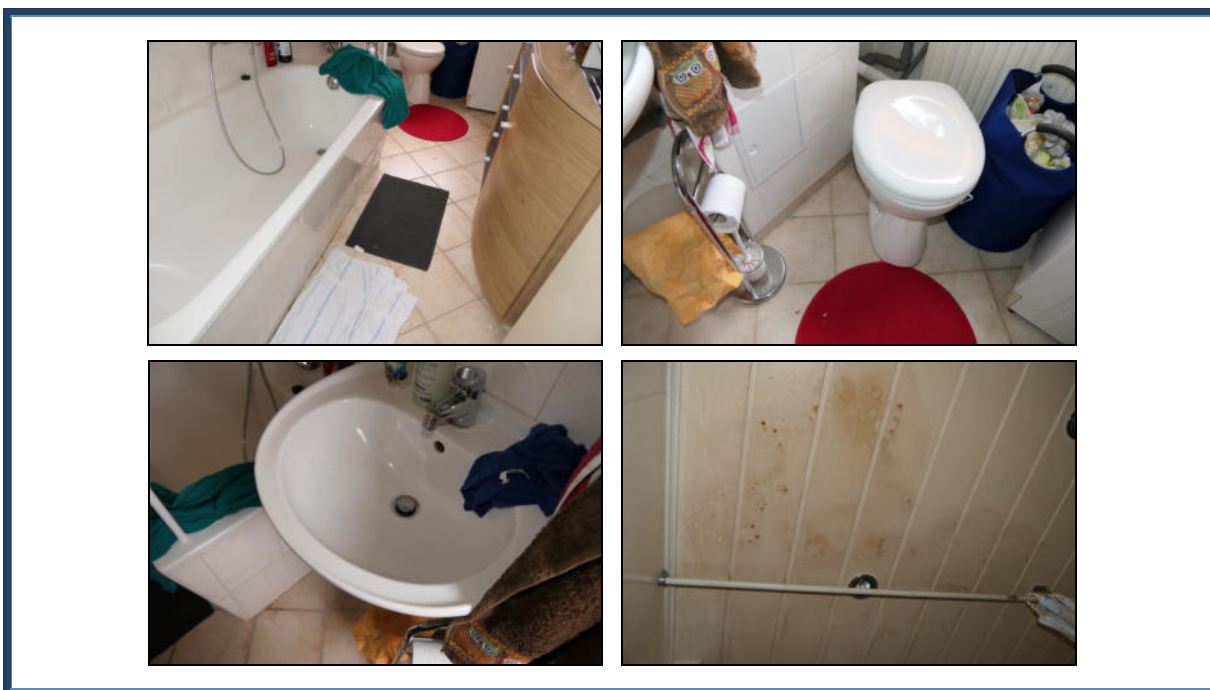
Detailansichten Badezimmer; Renovierungsbedarf im Deckenbereich (ehemaliger Wasserschaden)
